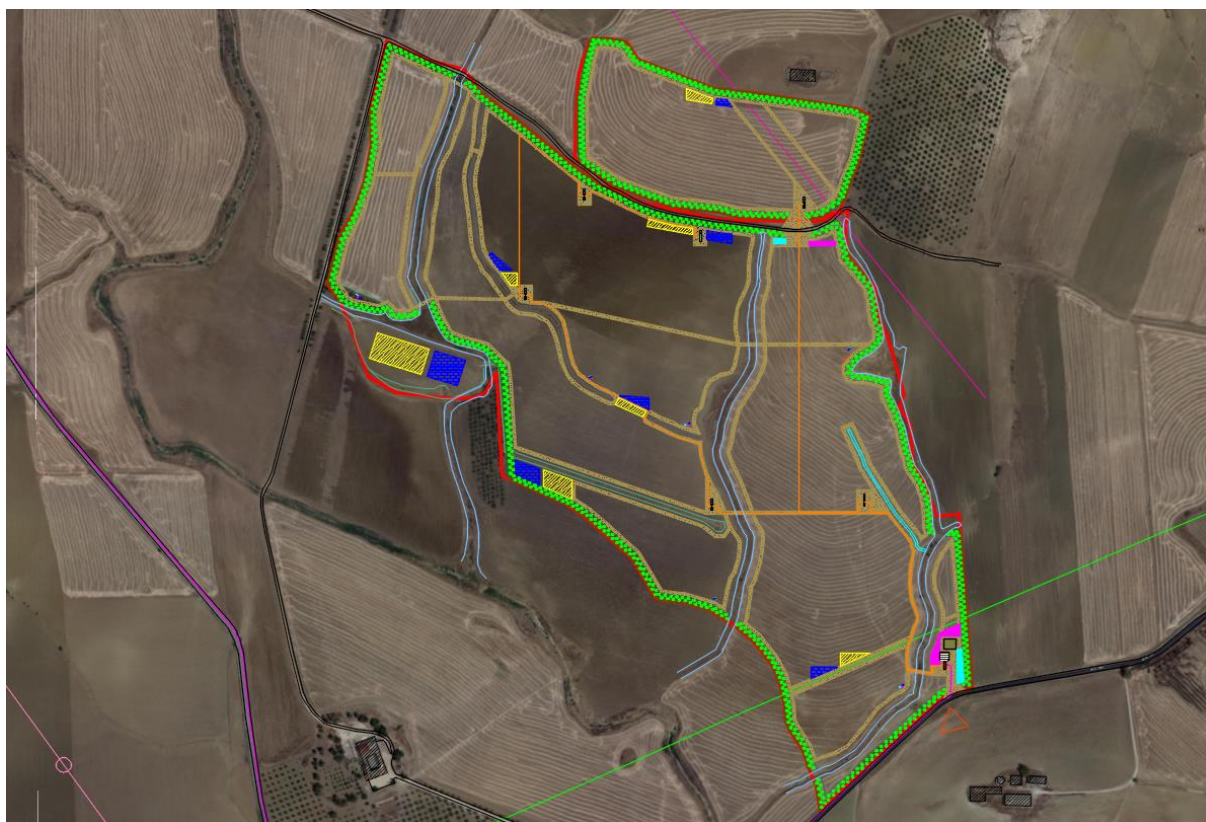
Piano di cantierizzazione lotto Nord con Individuazione dei punti di stoccaggio
